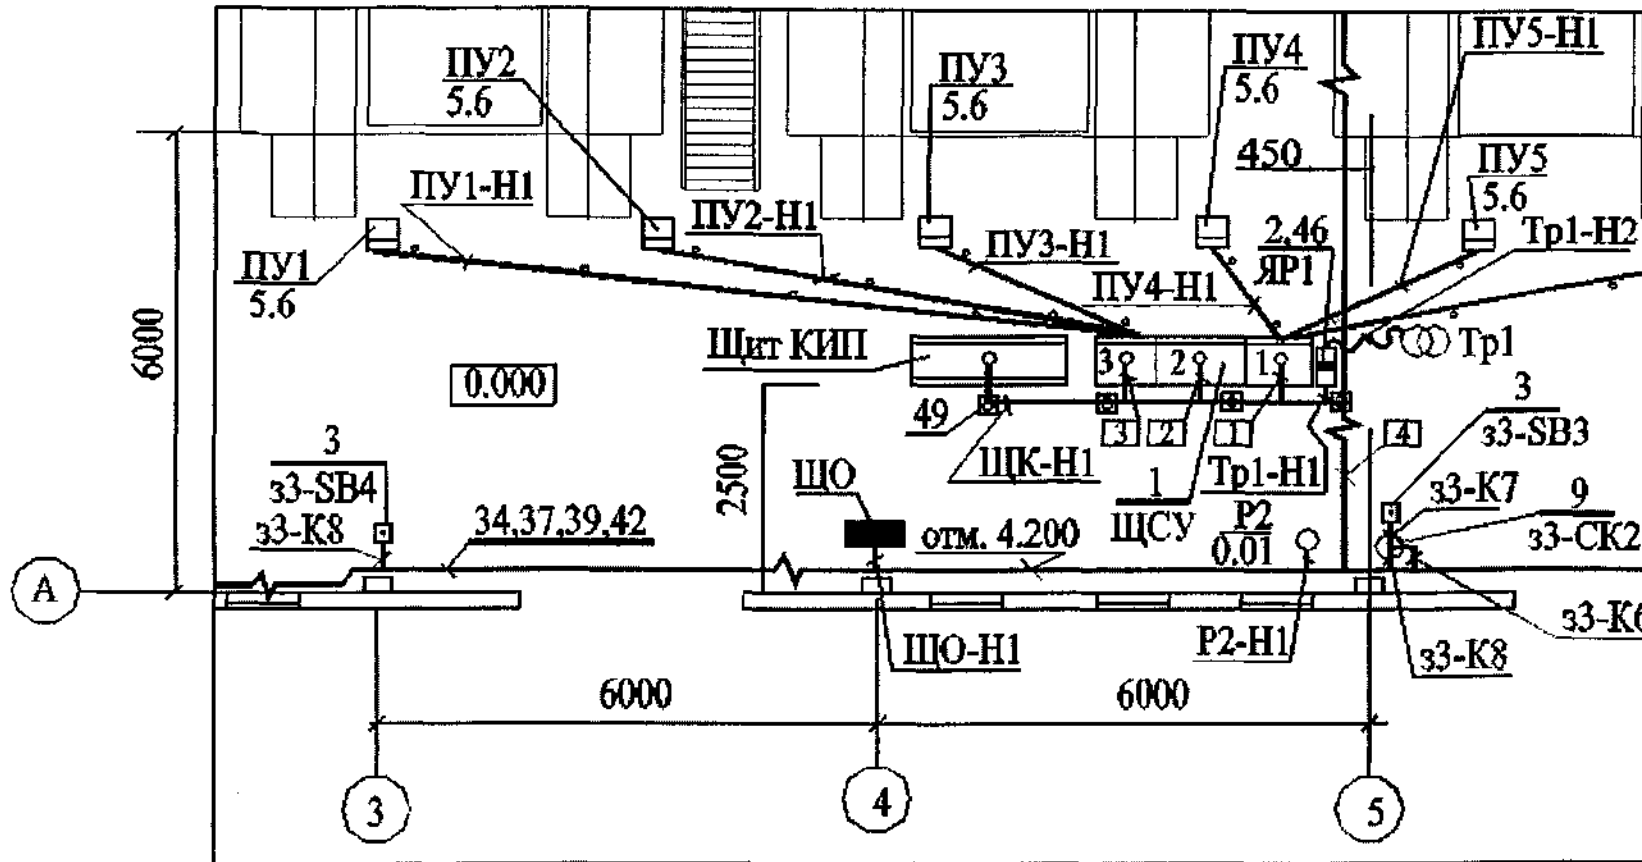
План прокладання електричних мереж відкрито на кабельних конструкціях і в трубах у підлозі
